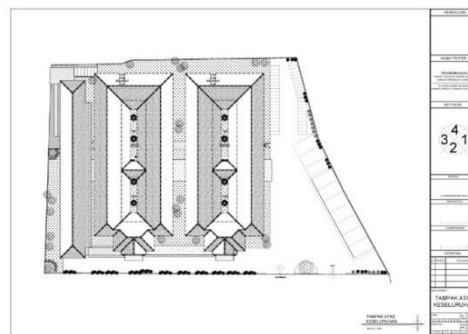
Gambar Siteplan Sasana Marsudi Husada
